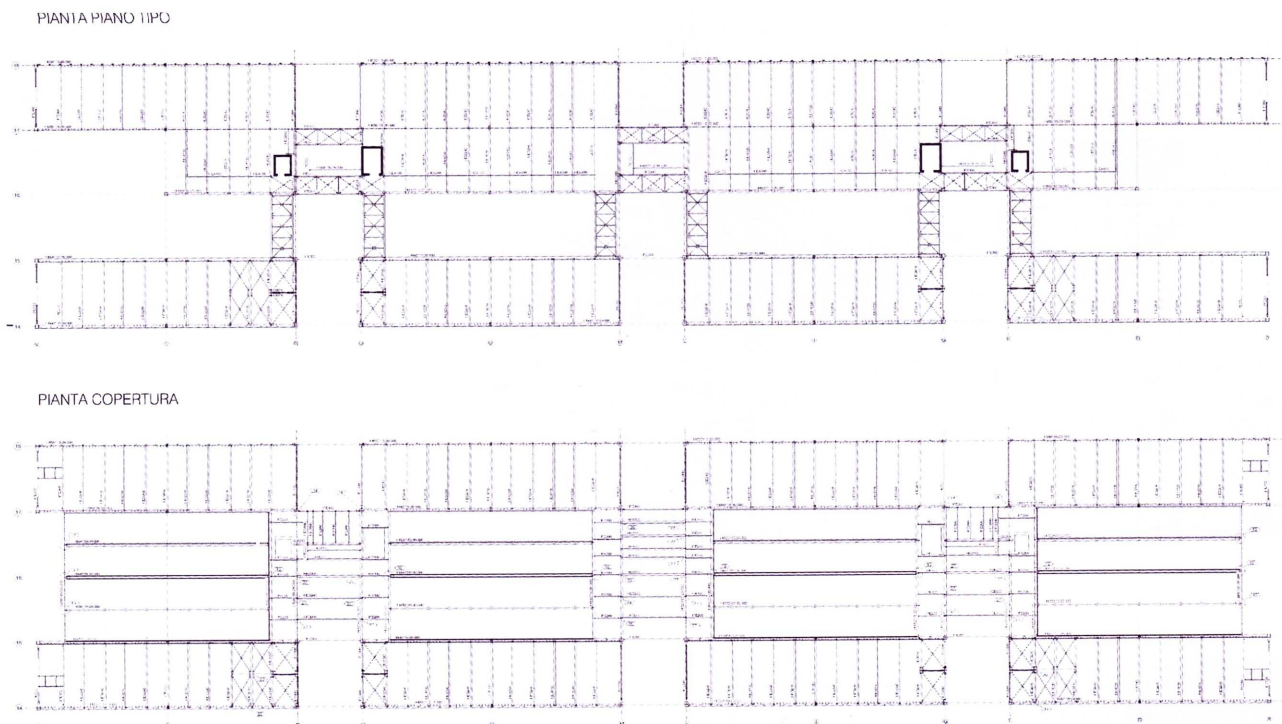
Piante tipo delle opere in carpenteria dei quattro blocchi dell'edificio
